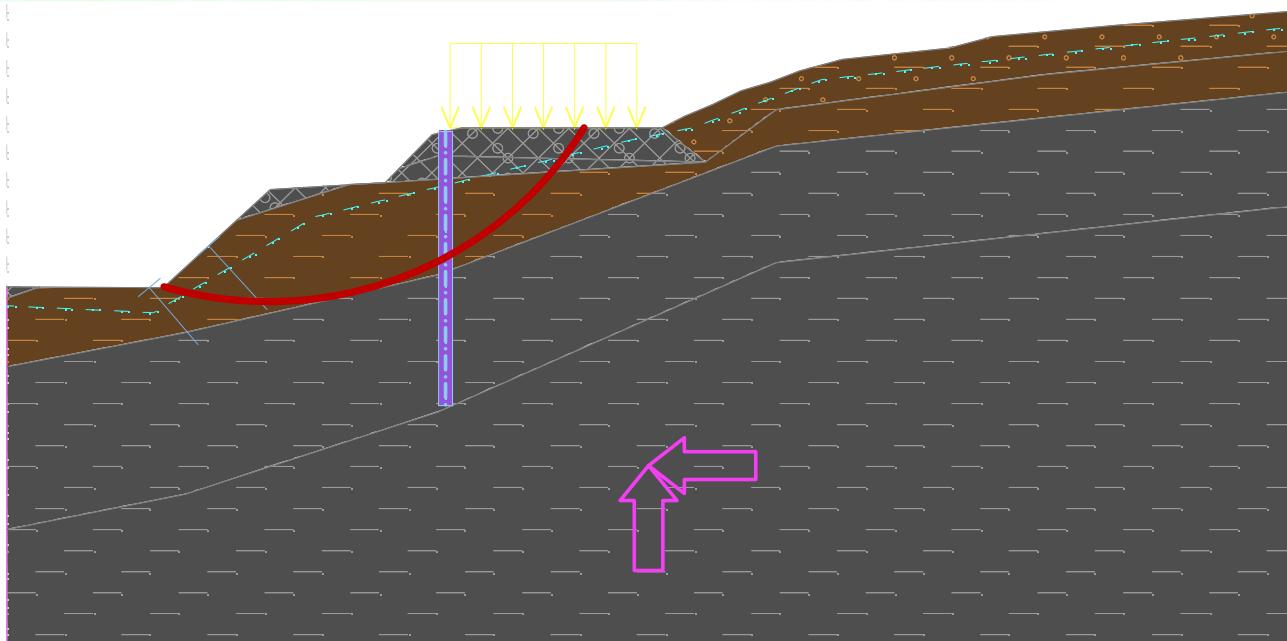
Profil litologic transversal și plan de situatie. Zona 7. Profil 2-2
